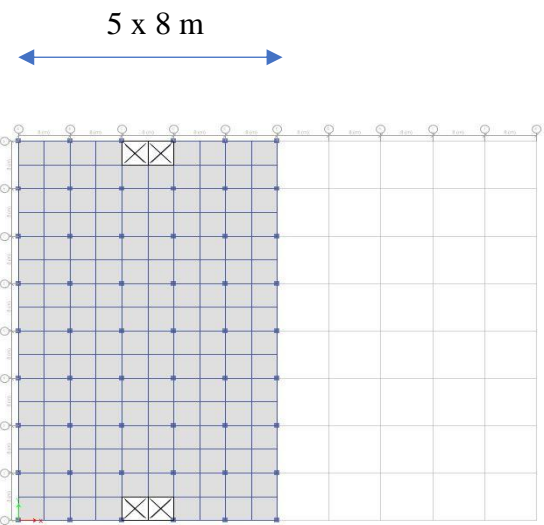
Denah Lantai 3 - Lantai 4 Model B1
